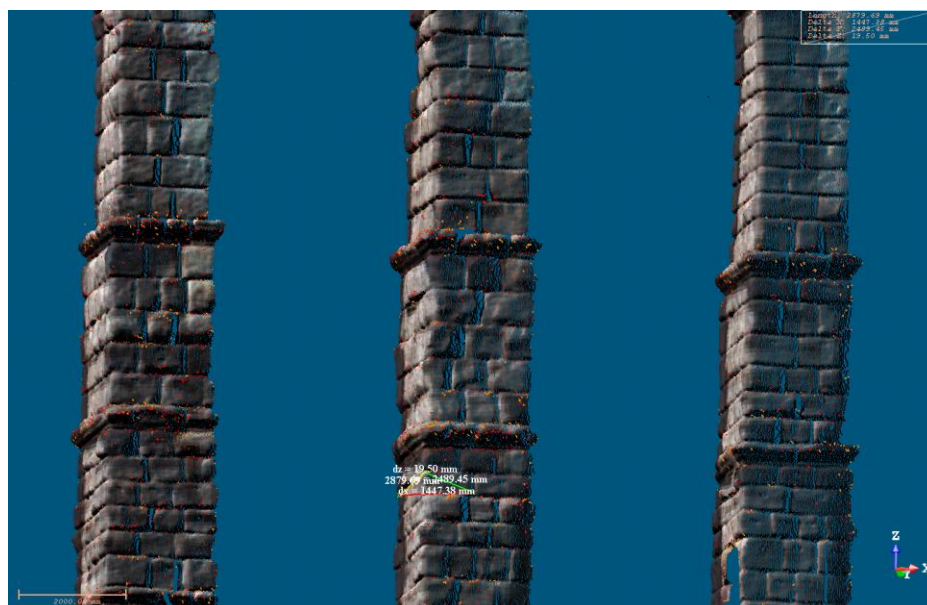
Toma de medidas en el orto alzado mediante el escáner 3D de Trimble.
